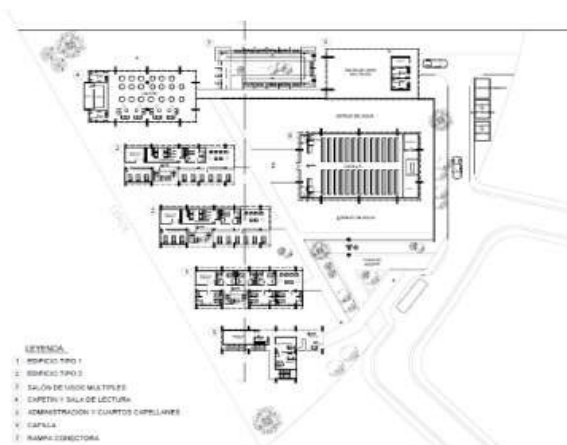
Planta baja conjunto de la Casa Hogar Semi-permanente. (2018)
